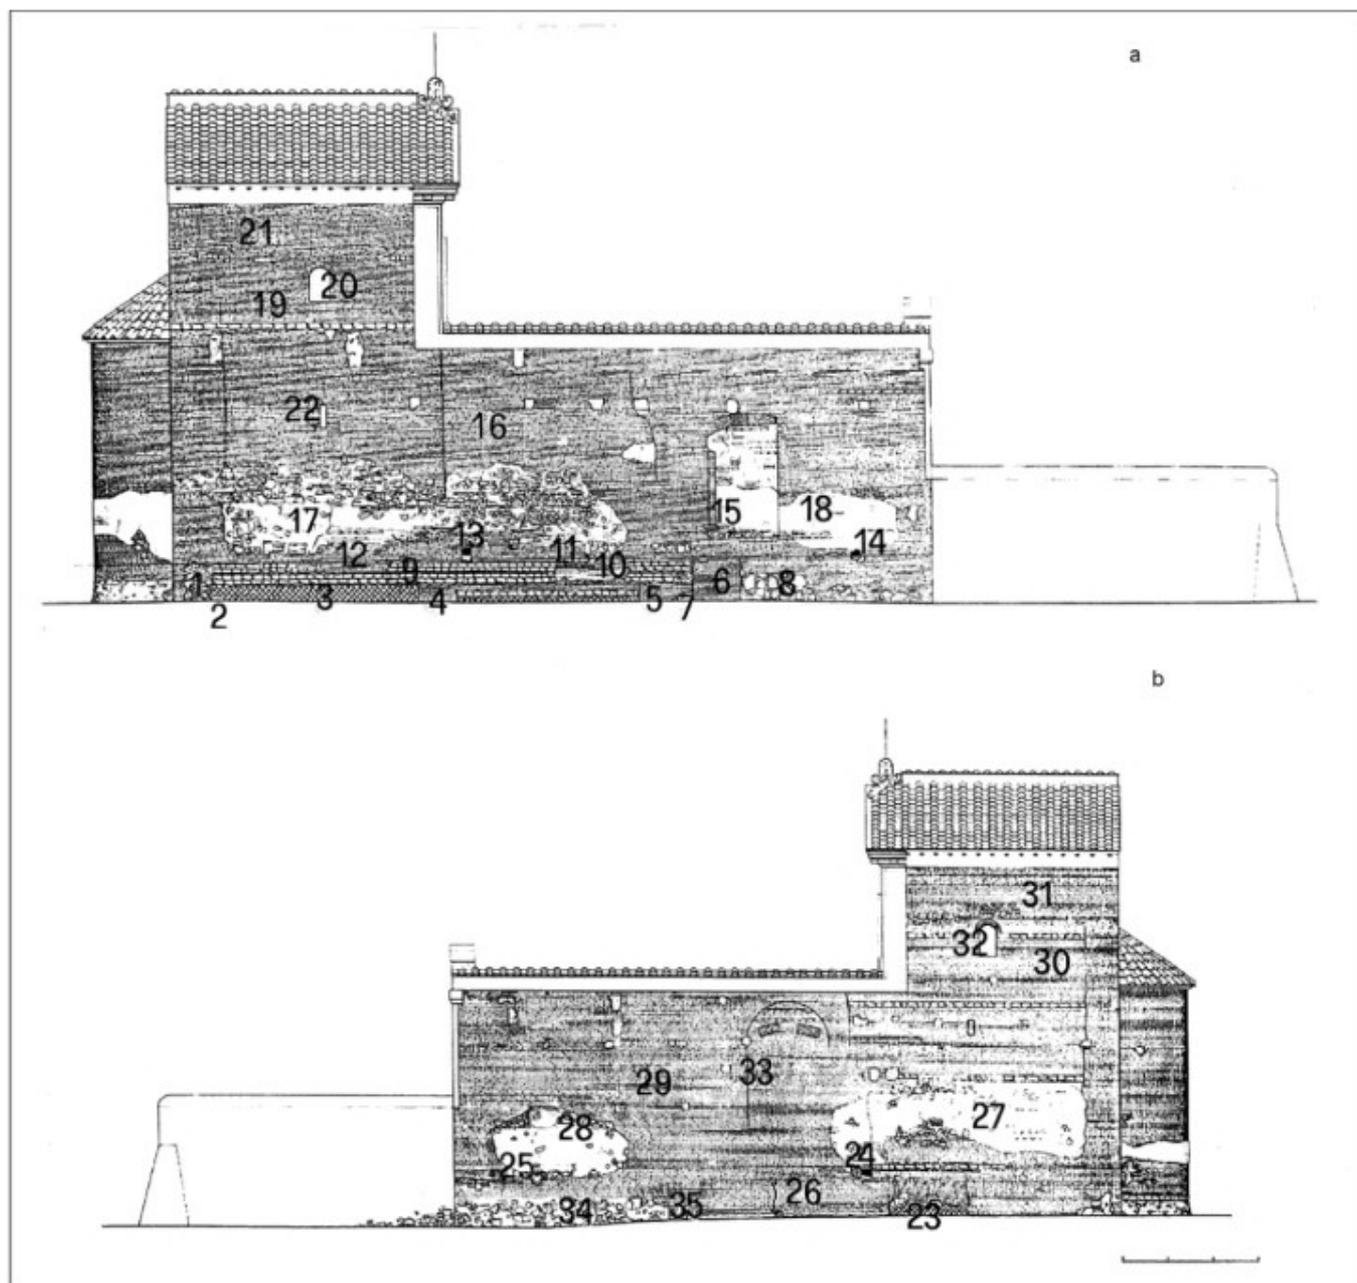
b – Ostia Antica, prospetto Sud e prospetto Nord della chiesa di S. Ercolano (Archivio Disegni SBAO, s.n.inu.).
